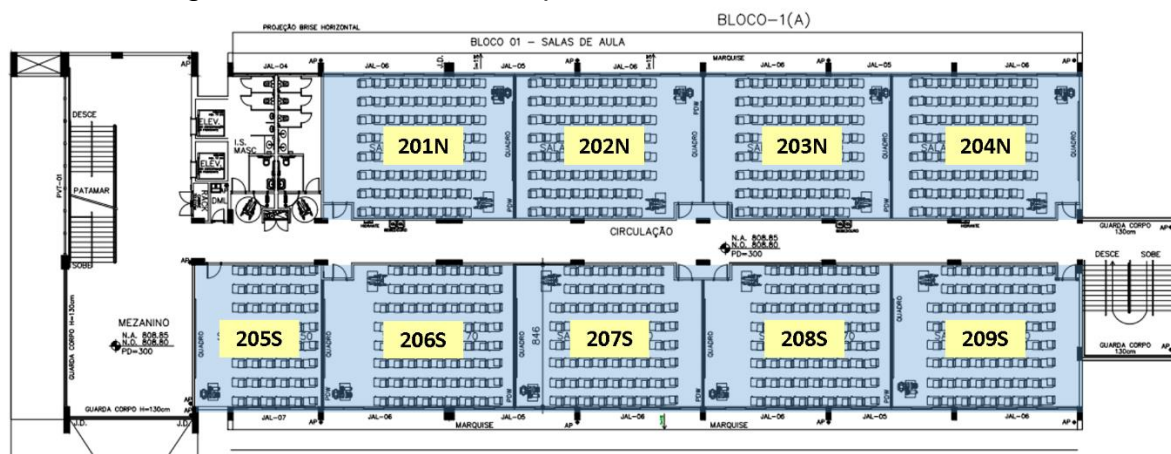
Planta-baixa do pavimento 3 do Bloco 1 do CAD 3
